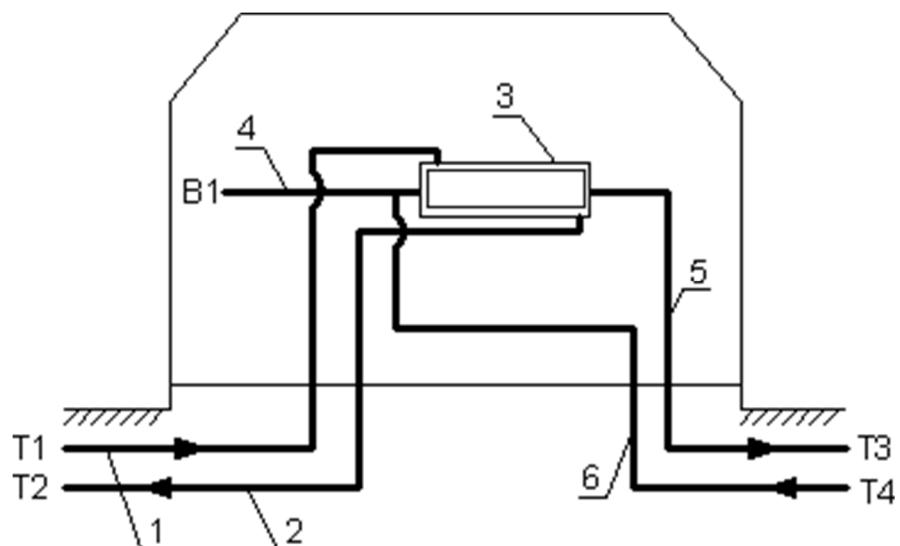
Схема ЦТП при открытой схеме горячего водоснабжения:
